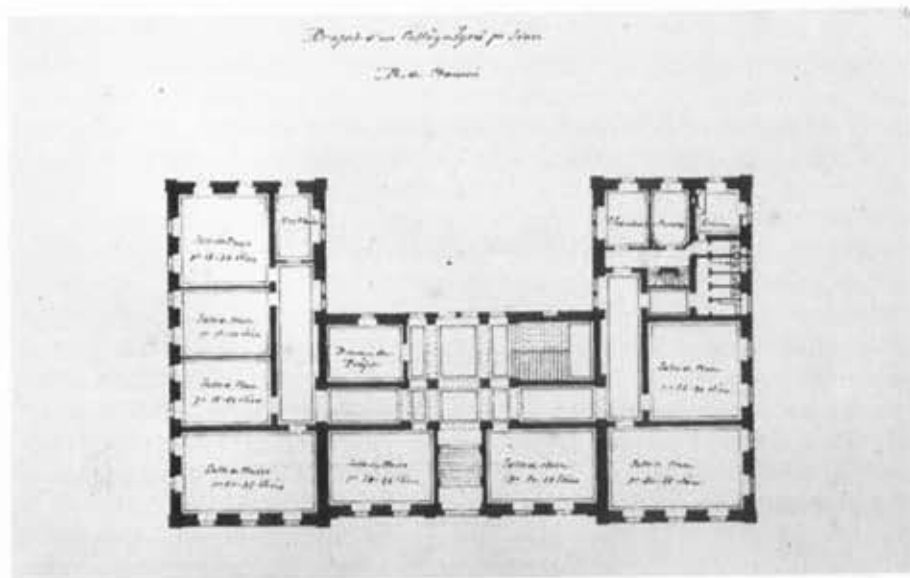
Joseph de Kalbermatten, 1873; plan du rez-de-chaussée. Archives de Kalbermatten architectes, déposées aux Archives Cantonales du Valais, B 75.
